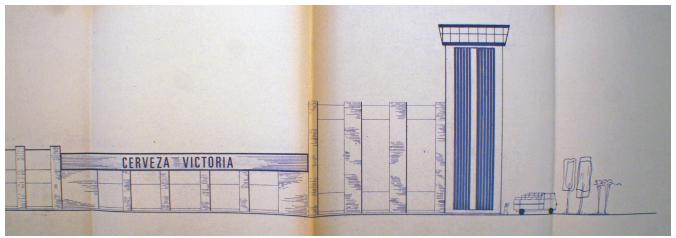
Alzado y sección de la nueva fábrica. Fachada sur (A.H.P.M.)
